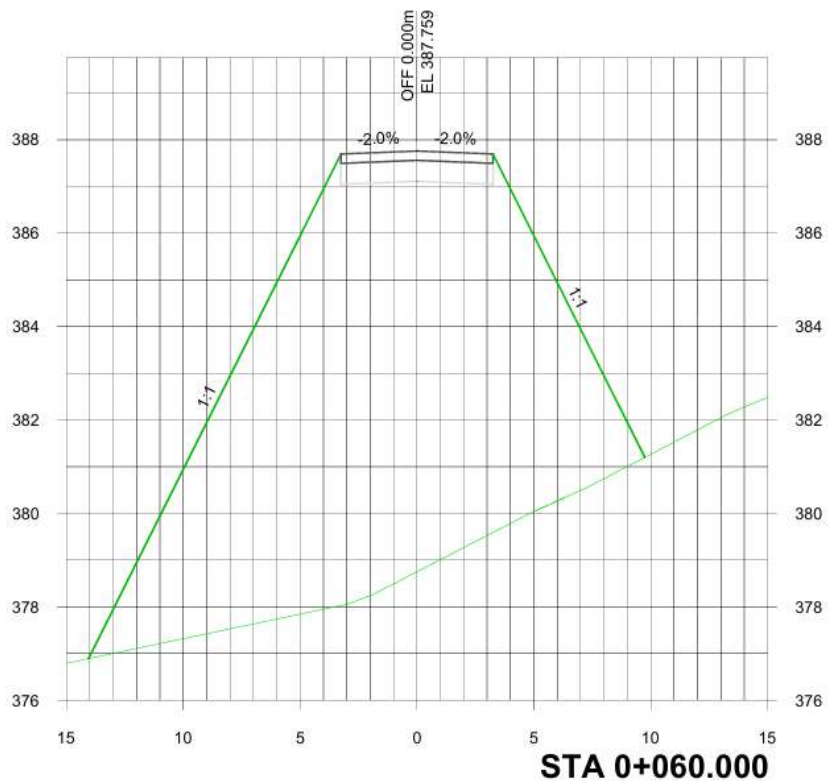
Perfil transversal EJE 14: STA 0 + 060,000
